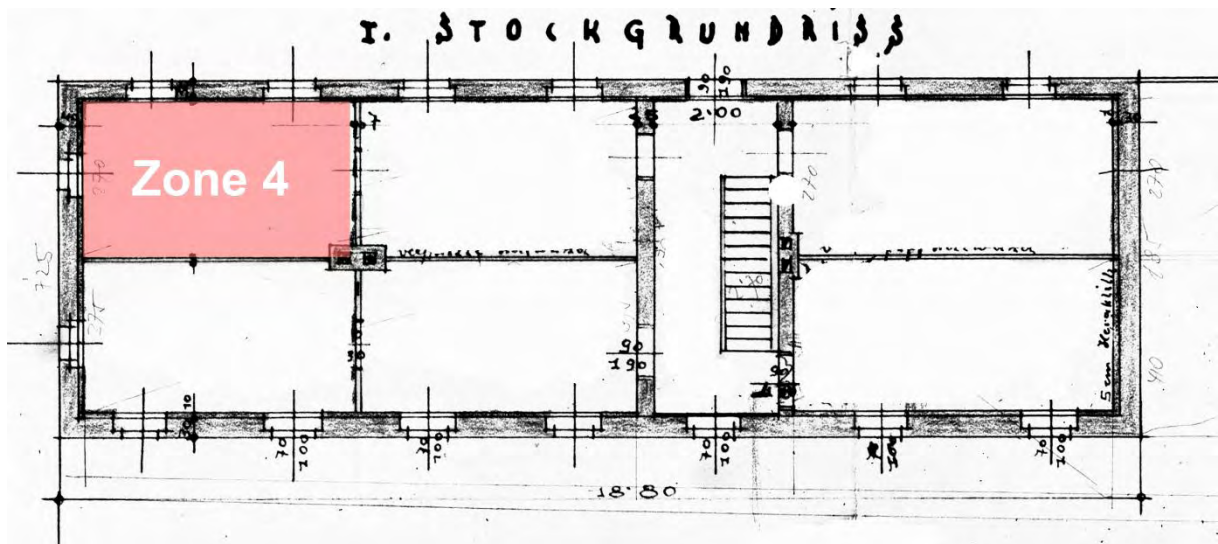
Grundriss Obergeschoß mit markiertem Bereich „Fußbodenaufbauten“ (Zone 4)
